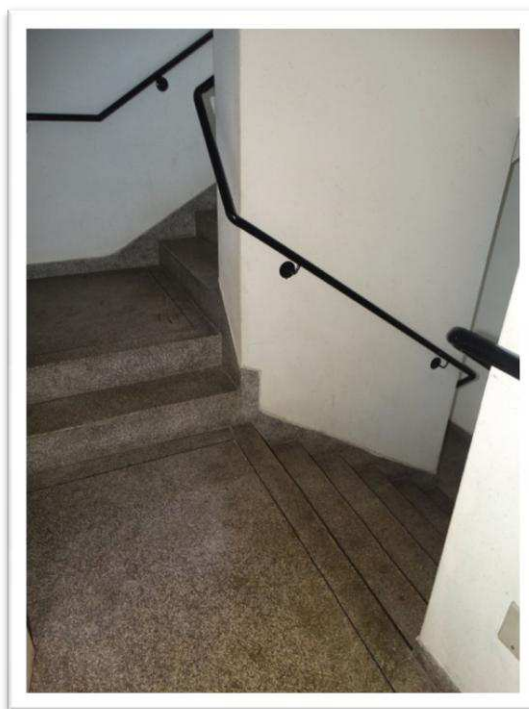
Vista da Caixa de Escada no 8º pavimento do Bloco “B”.
